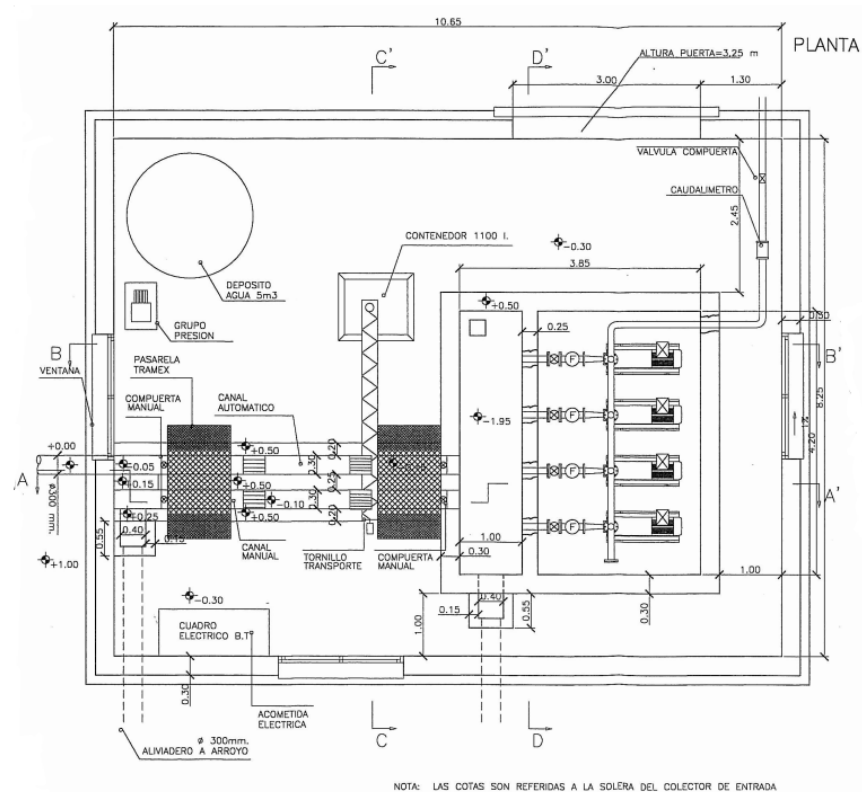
Planta de la EBAR de Villamanrique. Fuente: Proyecto de liquidación del modificado nº1 de las EDAR de Montiel, Torre de Juan Abad, Almedina, Villamanrique y Santa Cruz de los Cáñamos (Ciudad Real)
